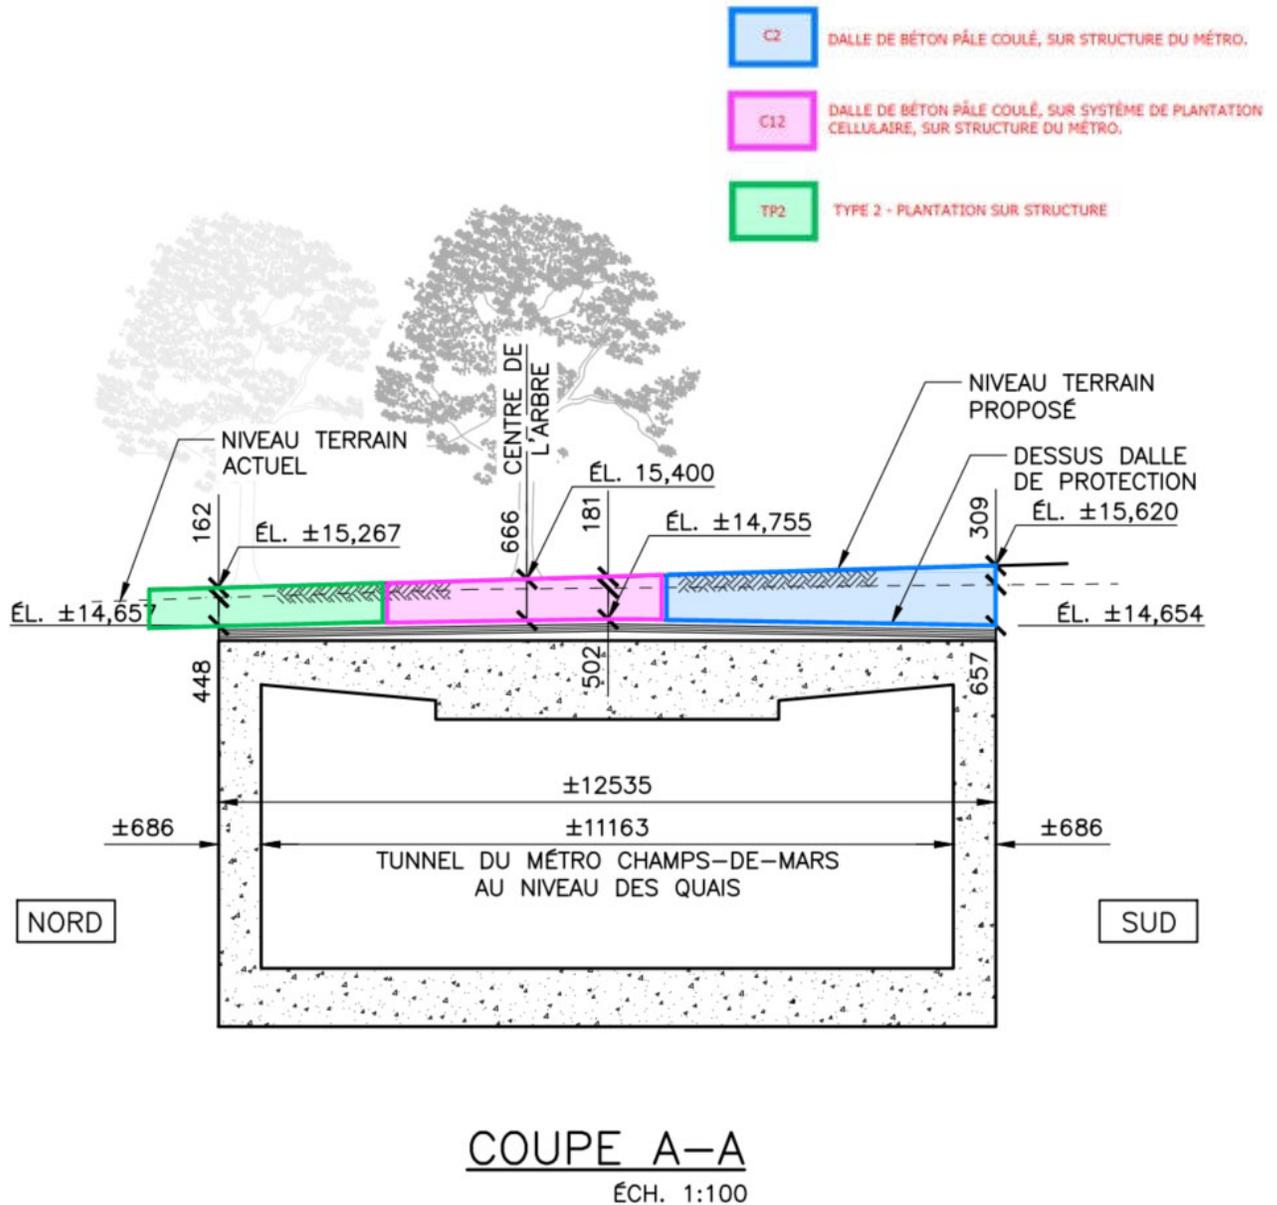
Exemple de coupe avec les niveaux, section A
